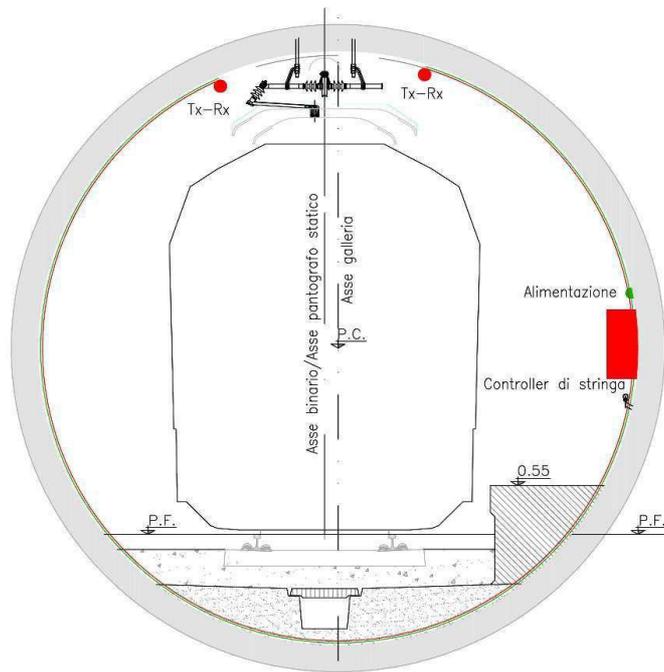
Disposizione dei rilevatori IR nella sezione a singolo binario (modificato da [1.2])
